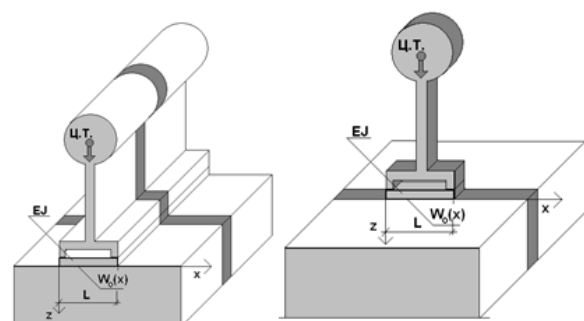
Расчетная схема системы «жесткое сооружение – деформируемая фундаментная плита – слой основания».
